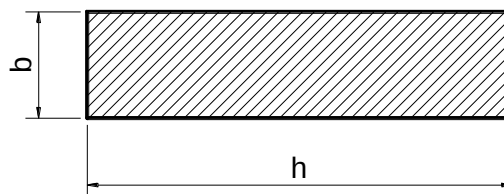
Classificação dos pilares e pilares-parede de seção retangular.
